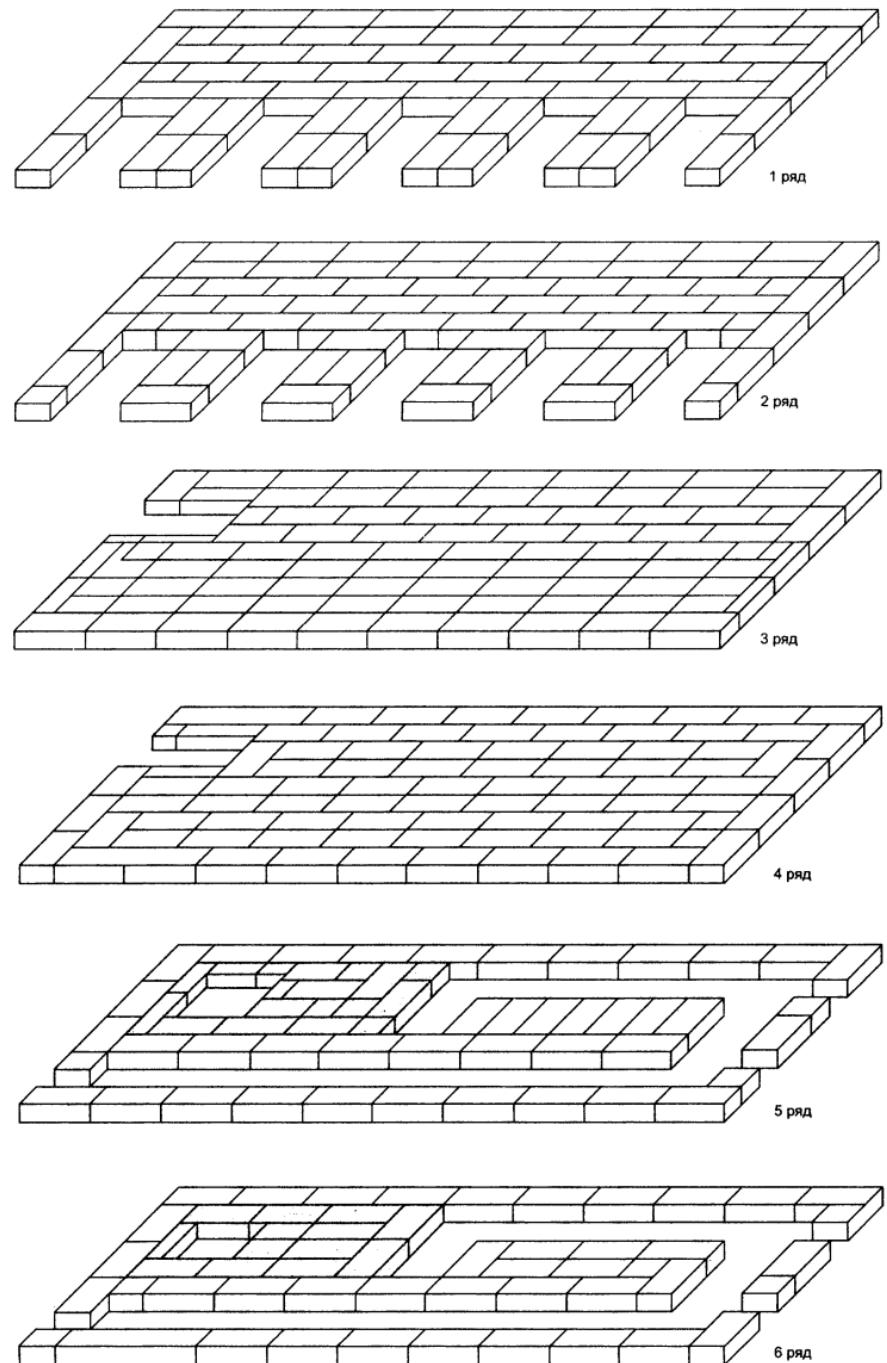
Кладка отопительной печи № 4А с лежанкой
